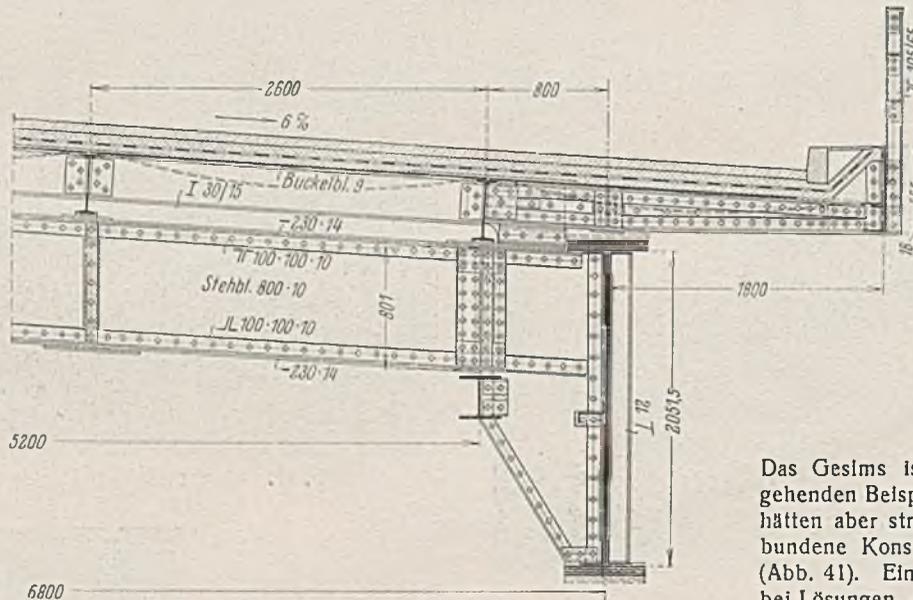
Brücke über die Waldkappeler Bahn und Leipziger Straße in Kassel. Querschnitt.
